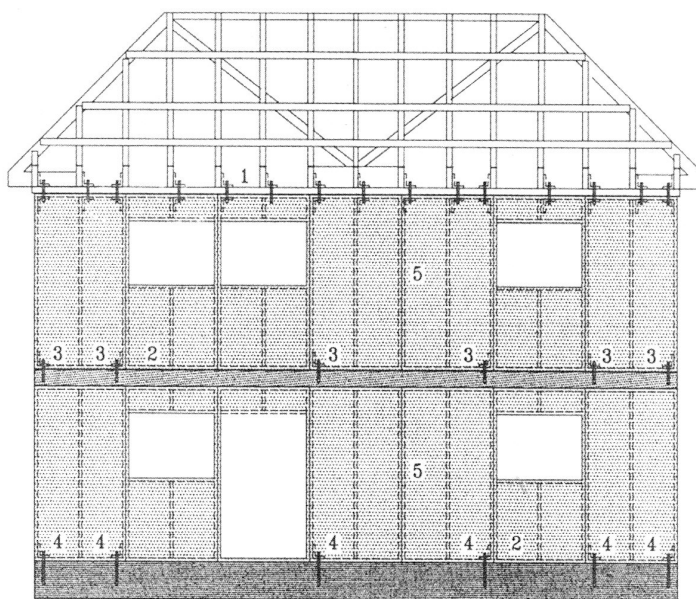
Liaisons mécaniques d'une maison à ossature bois
